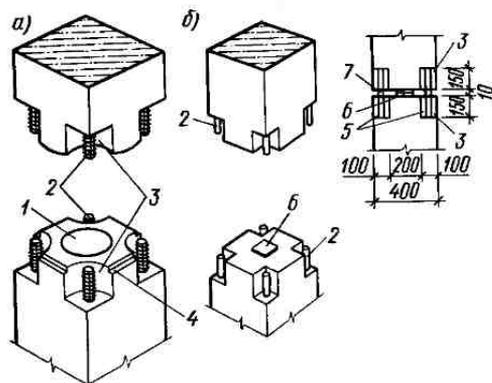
Типы стыков колонн: а — сферический, б — плоский безметалльный, 1 — сферическая бетонная поверхность, 2 — выпуски арматурных стержней, 3 — стыковочные ниши, 4 — паз для монтажа хомута, 5 — раствор или мелкозернистый бетон, 6 — центрирующий бетонный выступ, 7 — сварка выпусков арматуры
